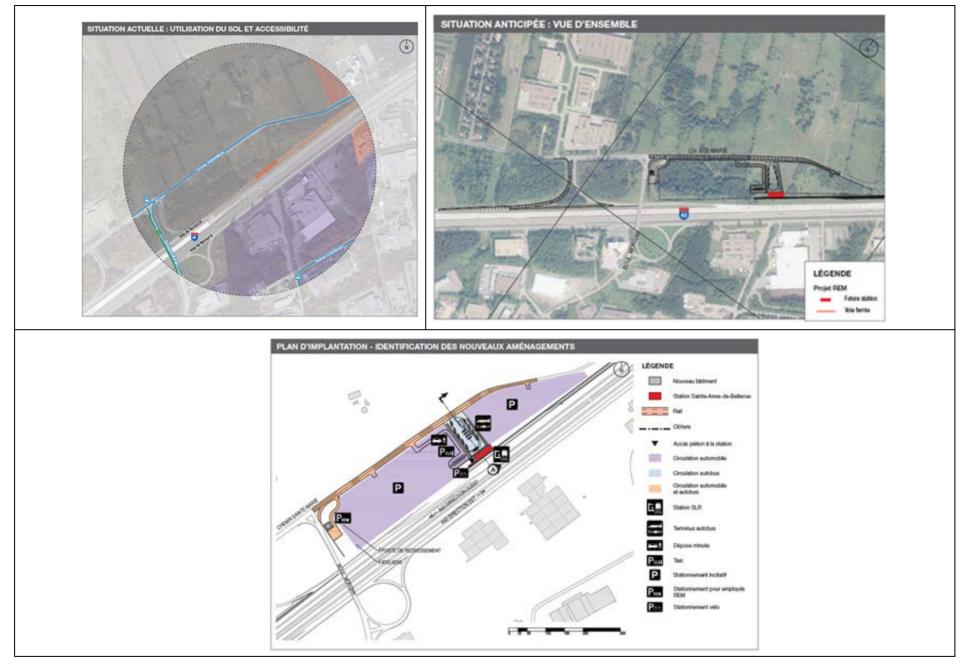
Plan d'implantation préliminaire de la station Sainte-Anne-de-Bellevue Note : ce plan est en cours de révision pour réduire l'empreinte au sol.
